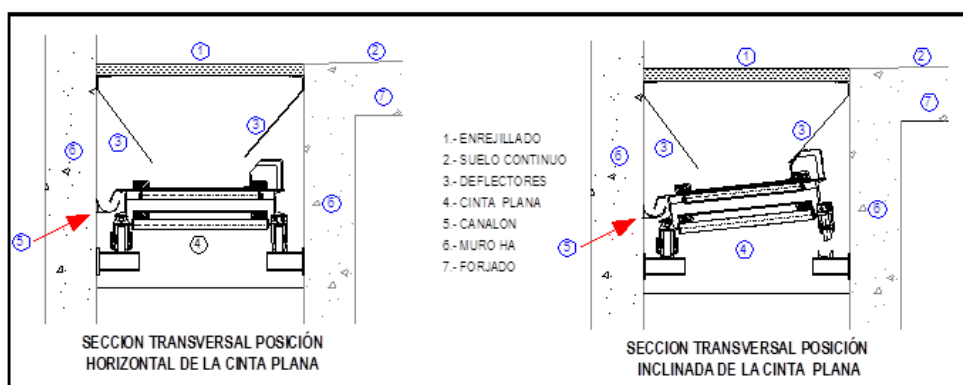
Esquema de las cintas planas situadas bajo el suelo enrejillado de las salas 1 y 4.
